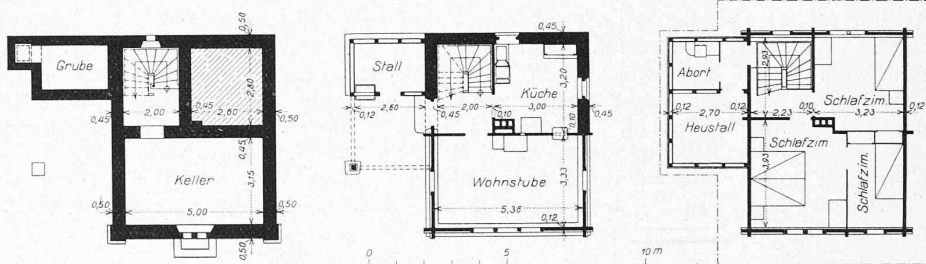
bis 3. Streckenwärter-Wohnhaus. — Grundrisse 1 : 250.
